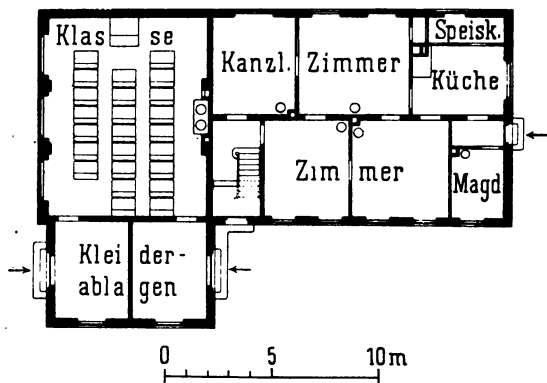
Grundriß eines einklassigen dänischen Landschulhauses.
